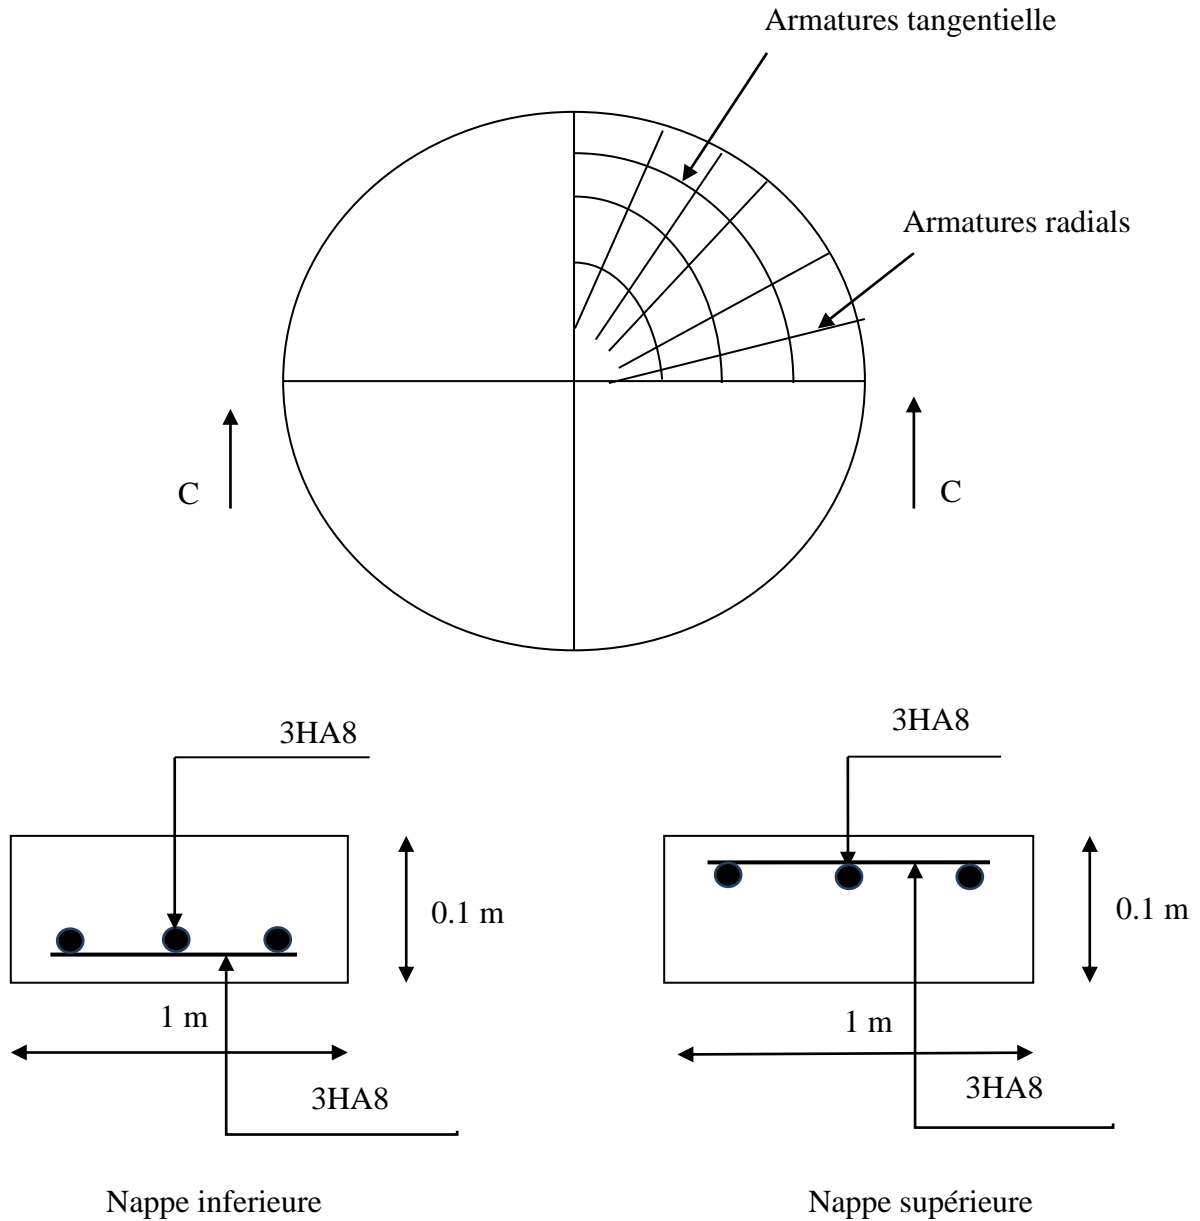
Schéma de ferrailage de la dalle circulaire de lanterneau.
